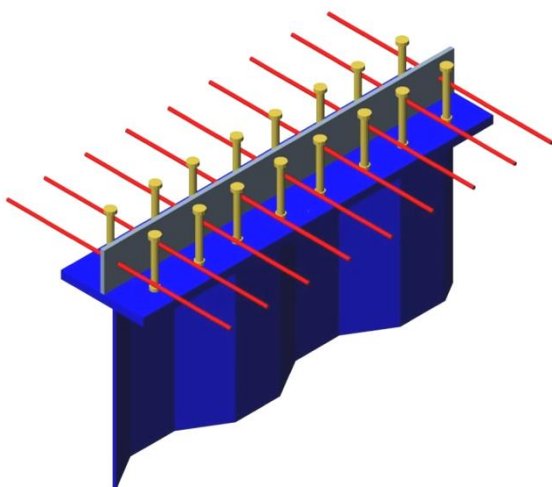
Verbundfuge mit Stahloberggurt, Kopfbolzen- und Betondübeln („Nakano Methode“)
